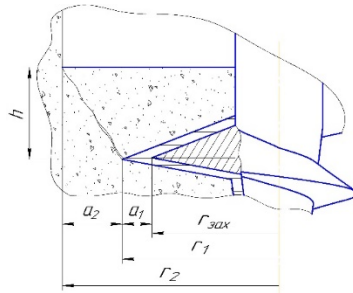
Схема основных параметров, влияющих на разрушение грунта
